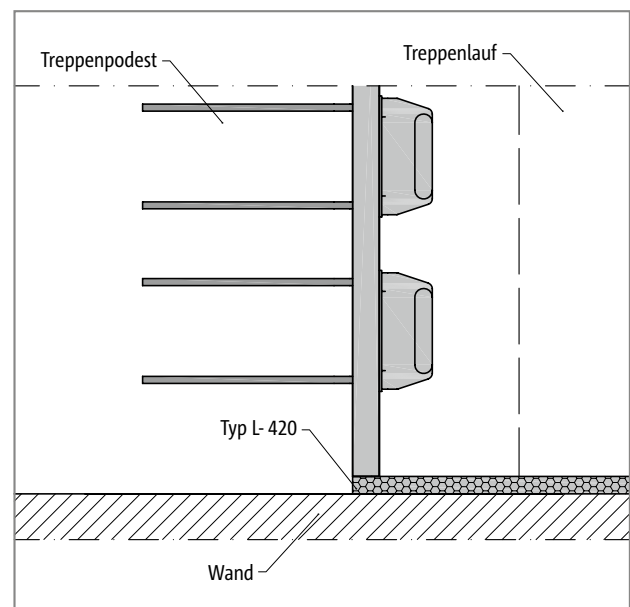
Schöck Tronsole® Typ T: Elementanordnung Detail B
